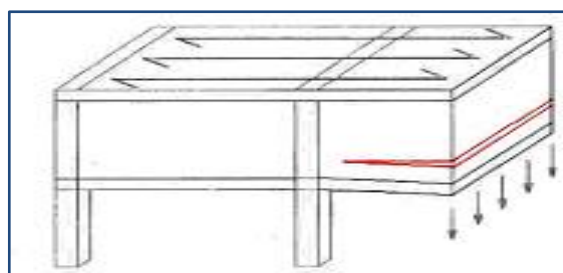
Distintas formas de fisuración en tabiques de mampostería, debido a deflexión excesiva en viga o losa de planta superior, de Rodriguez, (2011), Tesis de grado.
